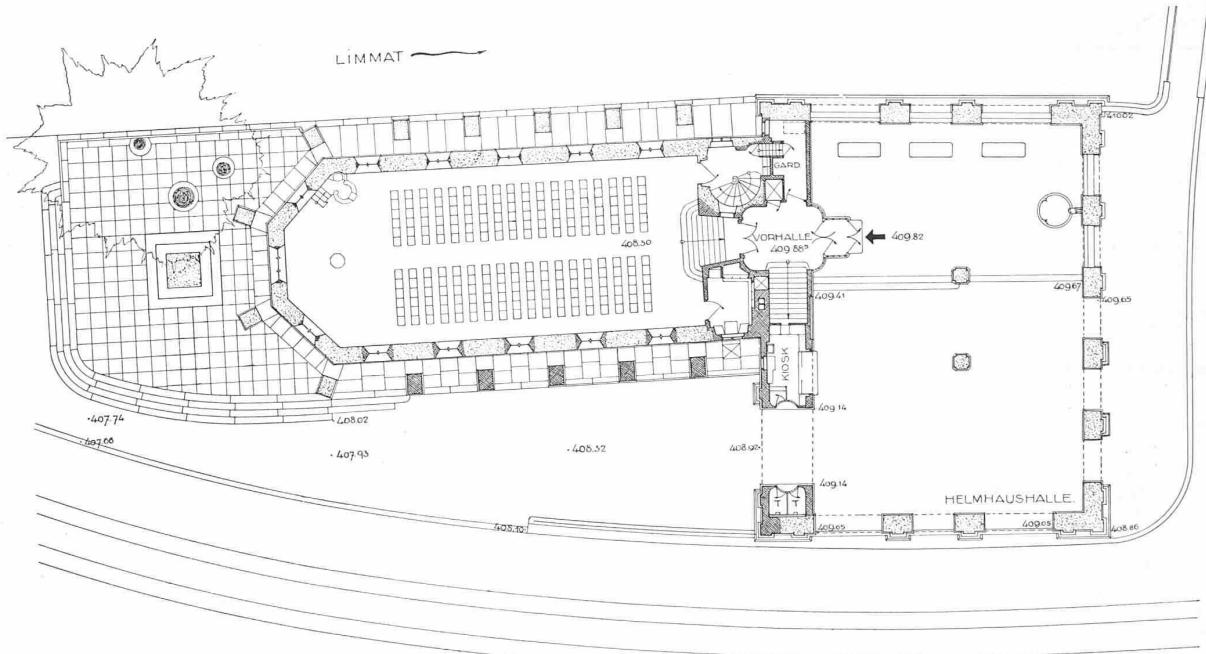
Erdgeschoss-Grundriss von Wasserkirche und Helmhaus. — Masstab 1:400
